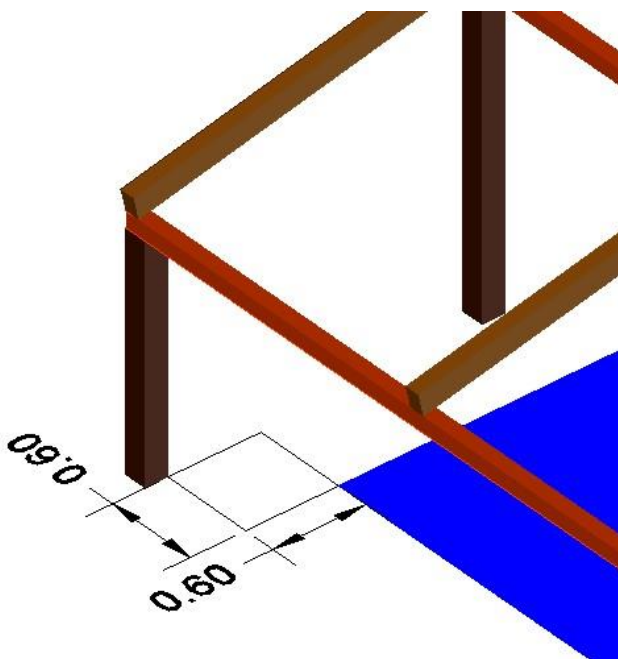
Distanciamiento desde la esquina del reservorio hasta las columnas que sostendrán la estructura. Fuente: Silva & Valencia, 2023
